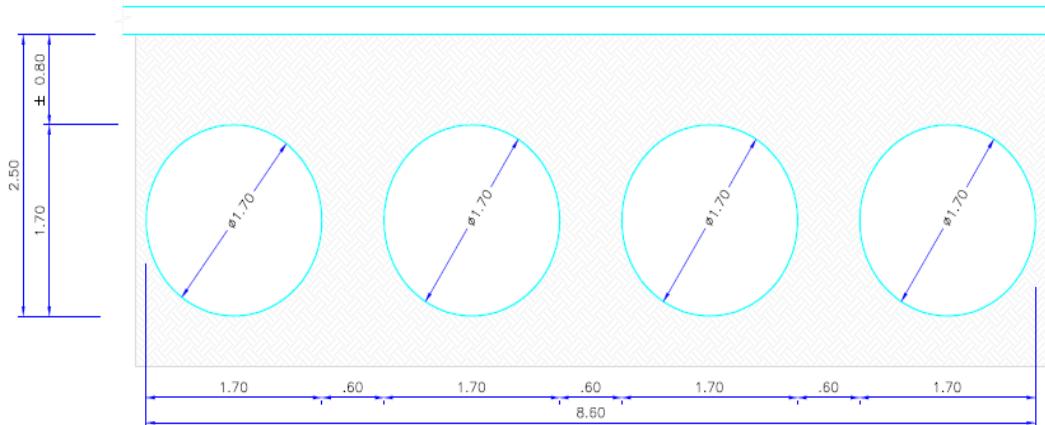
Planta de diseño Box Culvert PR 80+835. Fuente el solicitante
